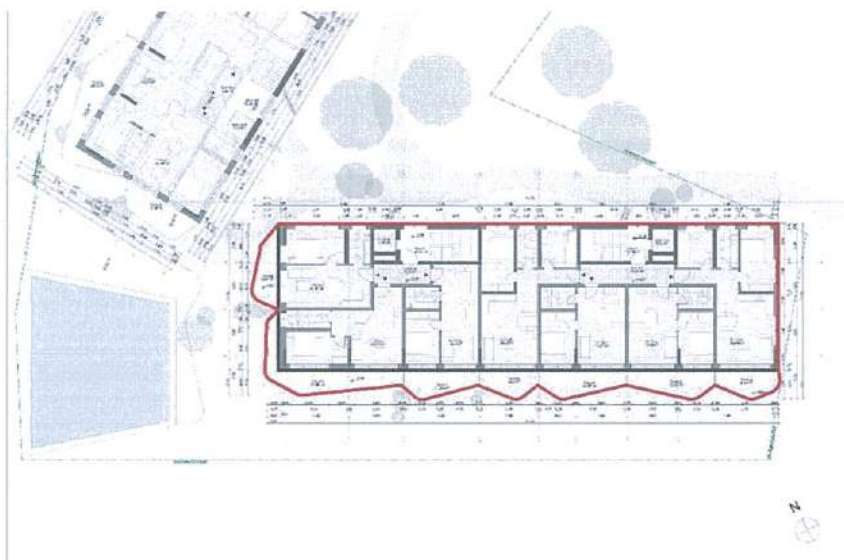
Planimetria e katit të parë – Sip. kati të parë 571.9m²
